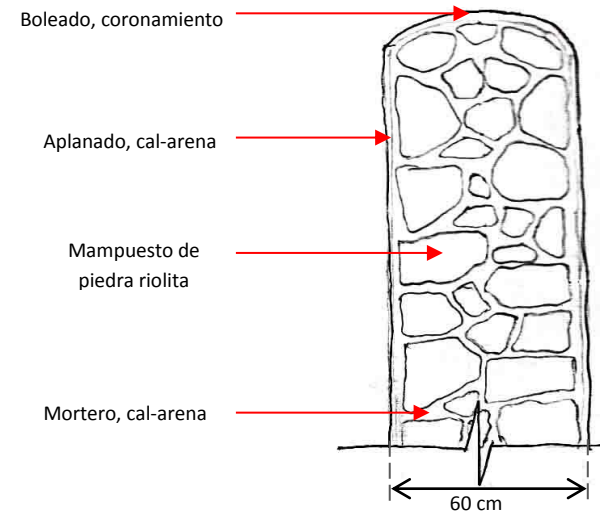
Croquis de detalle del sistema constructivo de muros. 2017.
